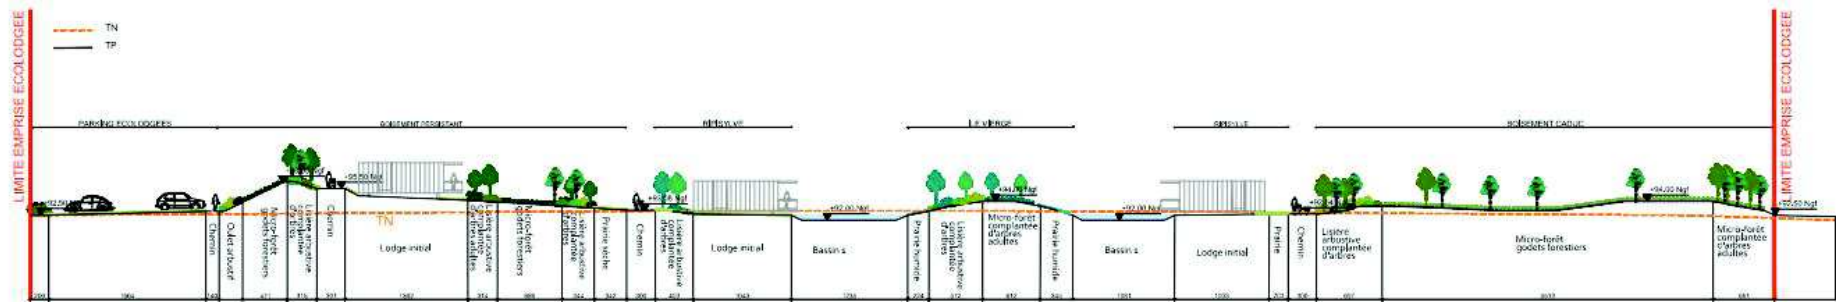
Coupes longitudinales du projet (Source : TANGRAM ARCHITECTES, ROUGERIE ARCHITECTES, CLAIRE ARCHIMBAUD)
